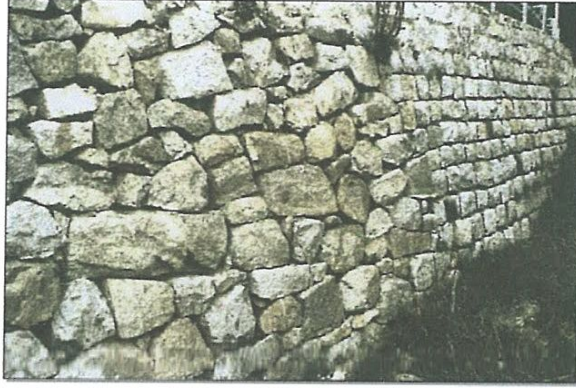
Mur poids en maçonnerie de pierres sèches non jointoyée
